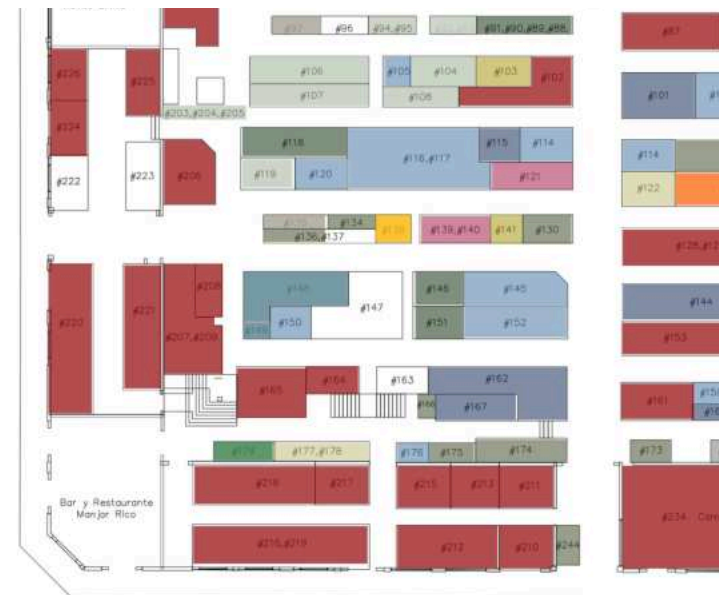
Acercamiento a planta de distribución de locales. (Fuente: propia, 2025)
